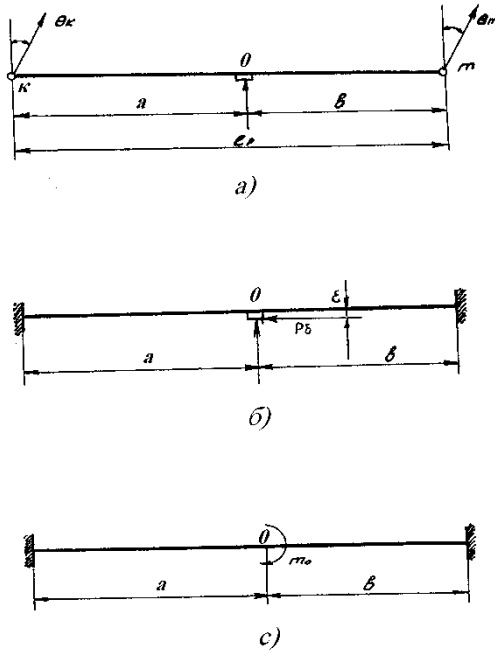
Расчетные схемы для определения нагрузок по методу начальных параметров
